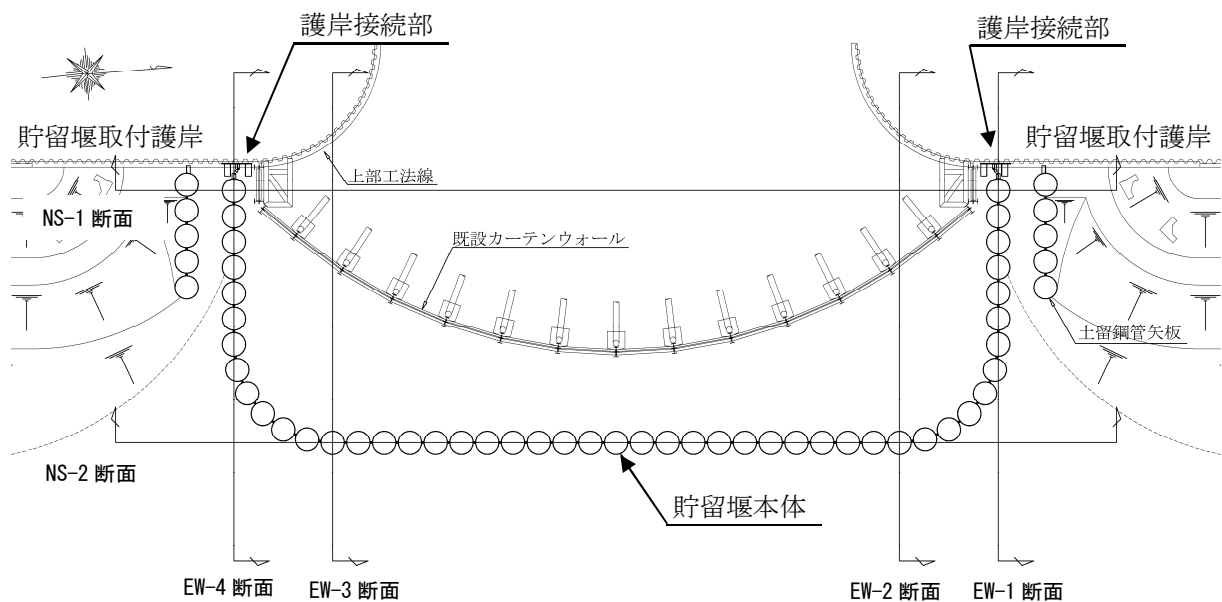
10. 6-1 貯留堰及び貯留堰取付護岸の平面配置図
